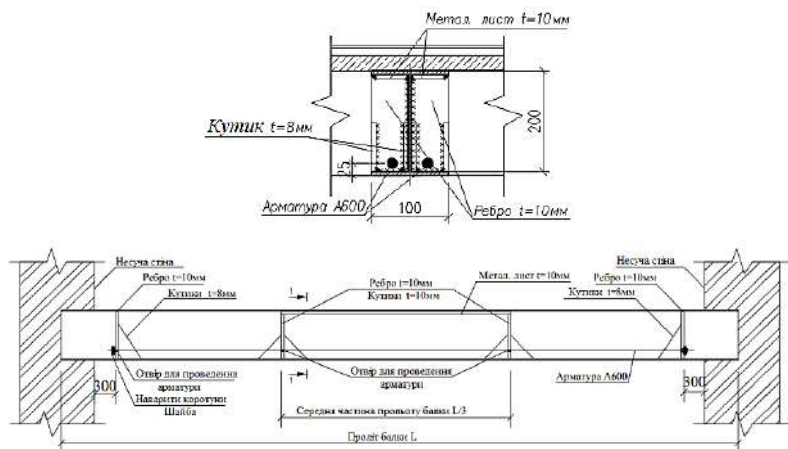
Підсилення балки монолітної плити перекриття по профнастилу попередньо-напруженою арматурою
